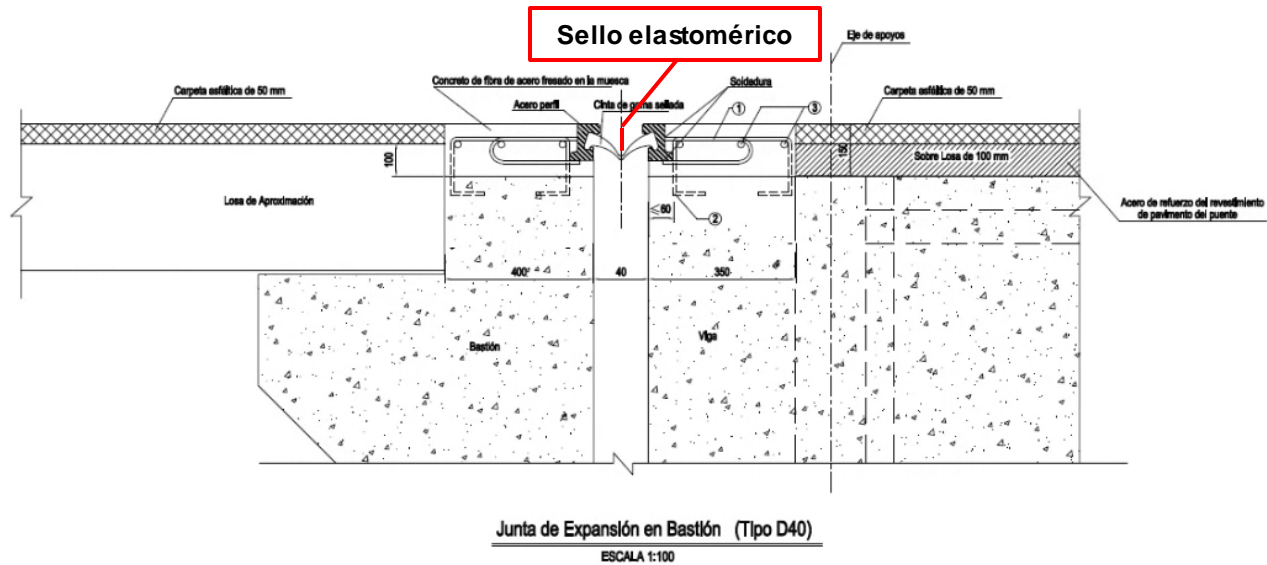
Detalle de la junta de expansión del puente nuevo sobre el río Guacimito.
